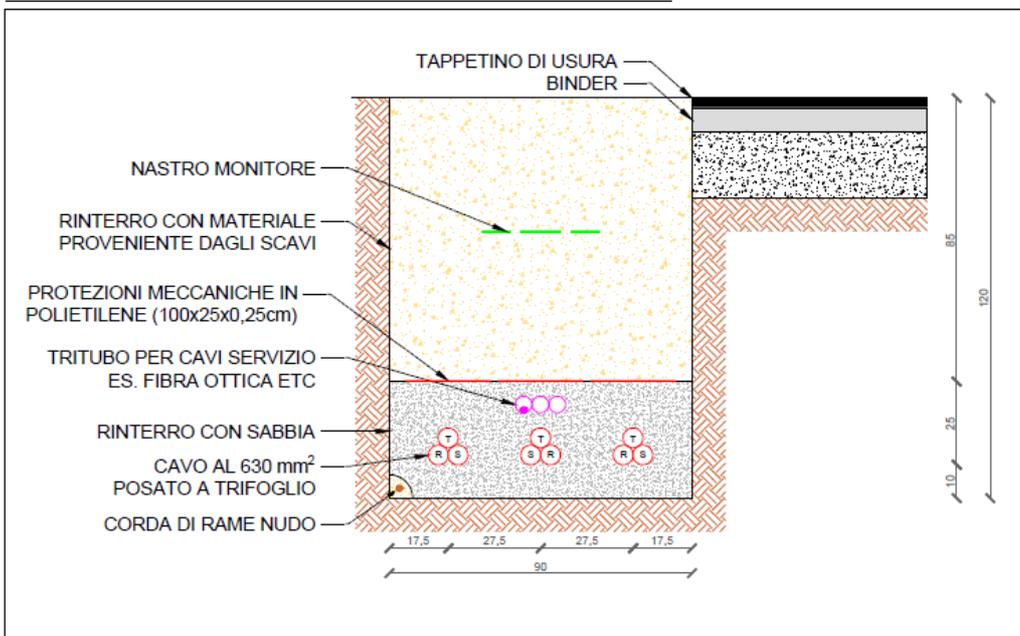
Sezione tipo di posa cavidotto M.T. in banchina stradale
